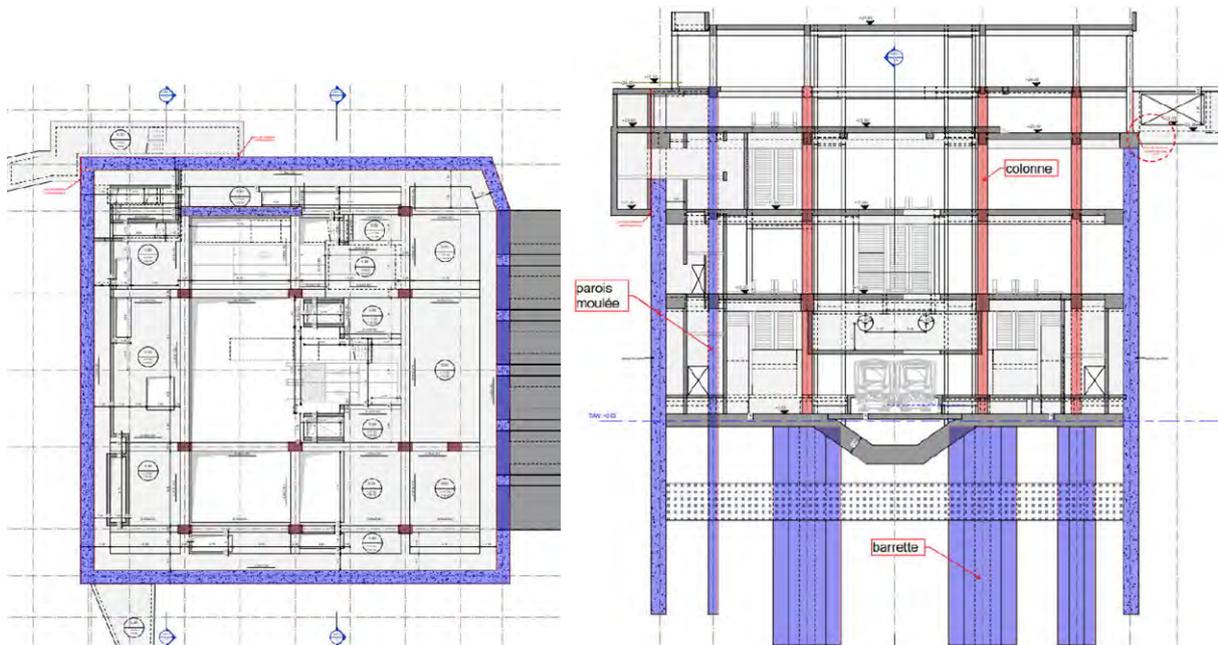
Vue en plan (à gauche) et en coupe (à droite) des éléments structuraux de la boîte sud de la station Verboekhoven – parois moulées en bleu et colonnes en rouge (BMN, 2020)
